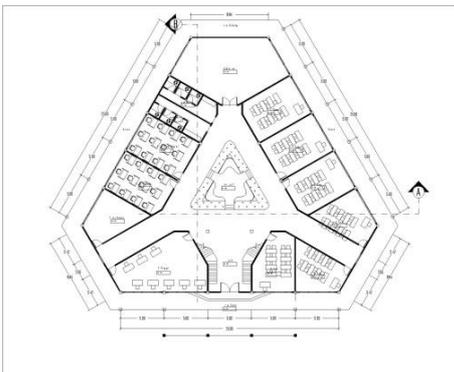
Denah Lantai 1 Ged. B (Retail)
